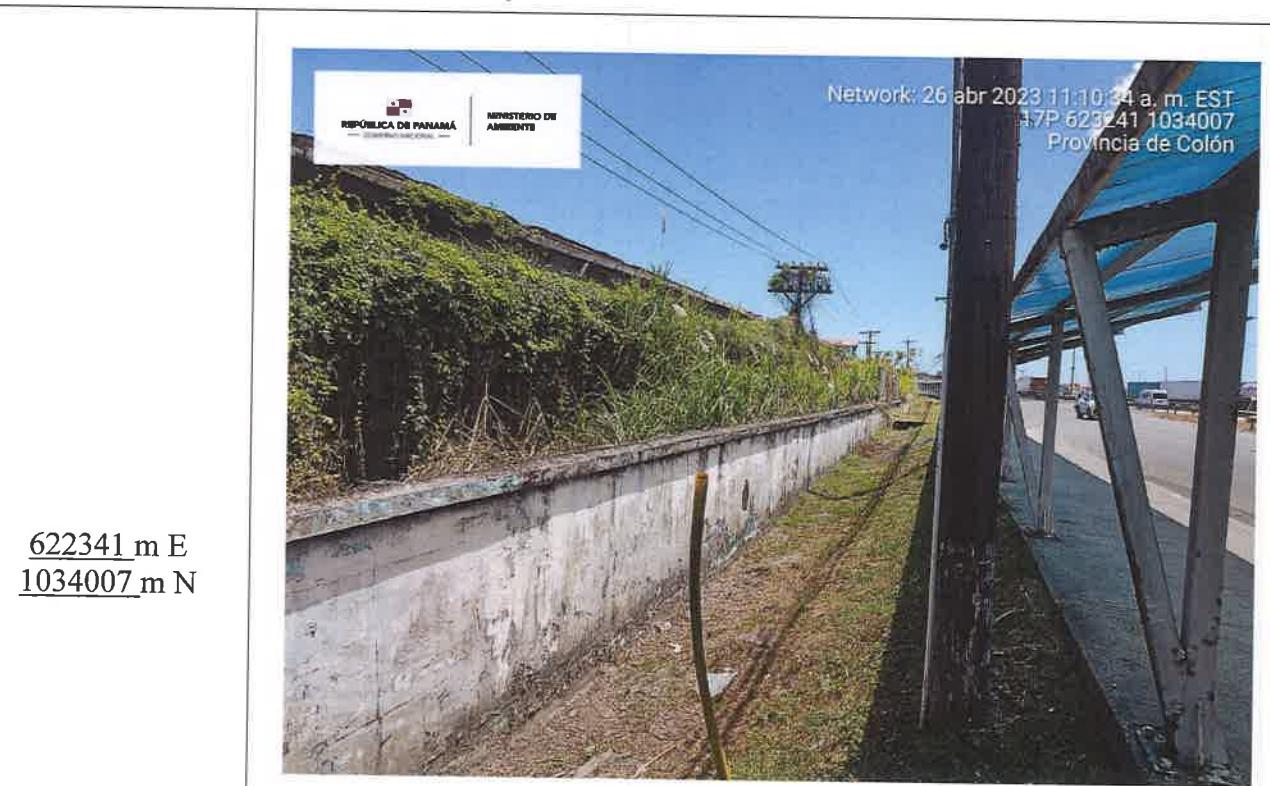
Punto final del alineamiento correspondiente a la Calle 13, la flecha indica el muro perimetral existente.
